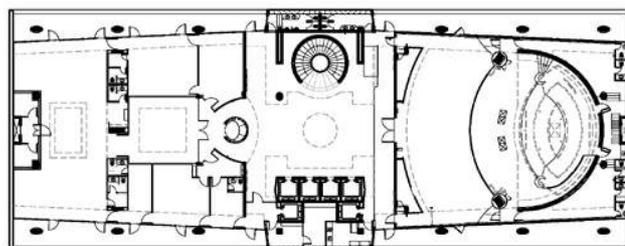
Planta baixa do 6º pav.: a ala norte prevista mas não ocupada da ampla presidência
